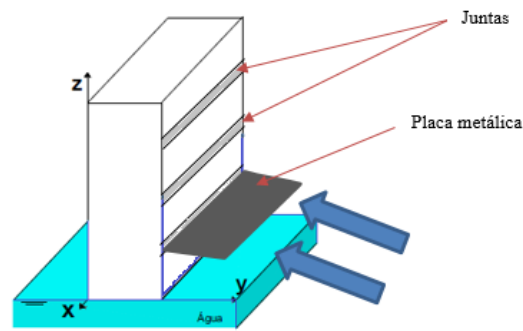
Aplicação de placas metálicas nas juntas da parede
